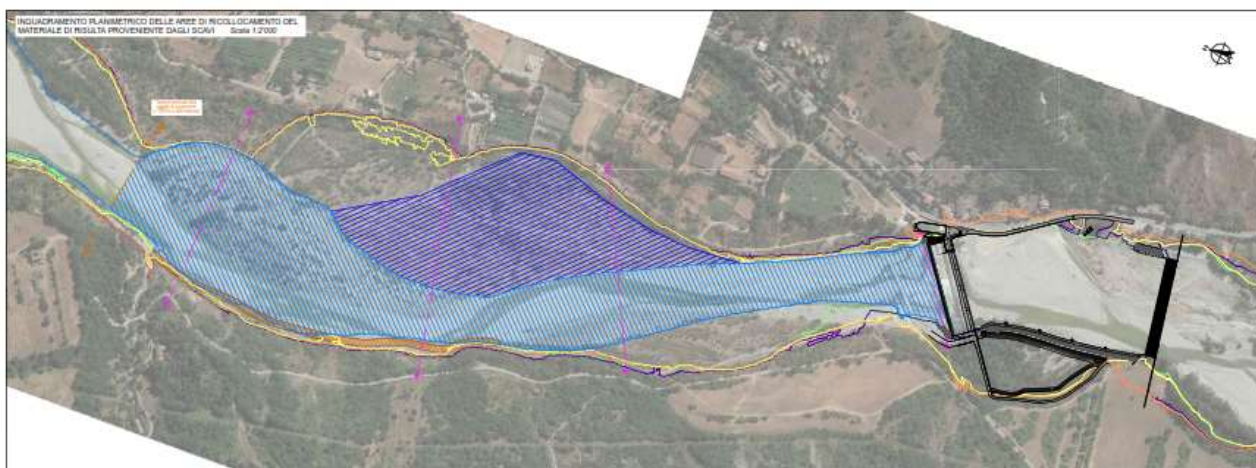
planimetria delle aree di riporto a valle – estratto di tavola di progetto 3.6.1
